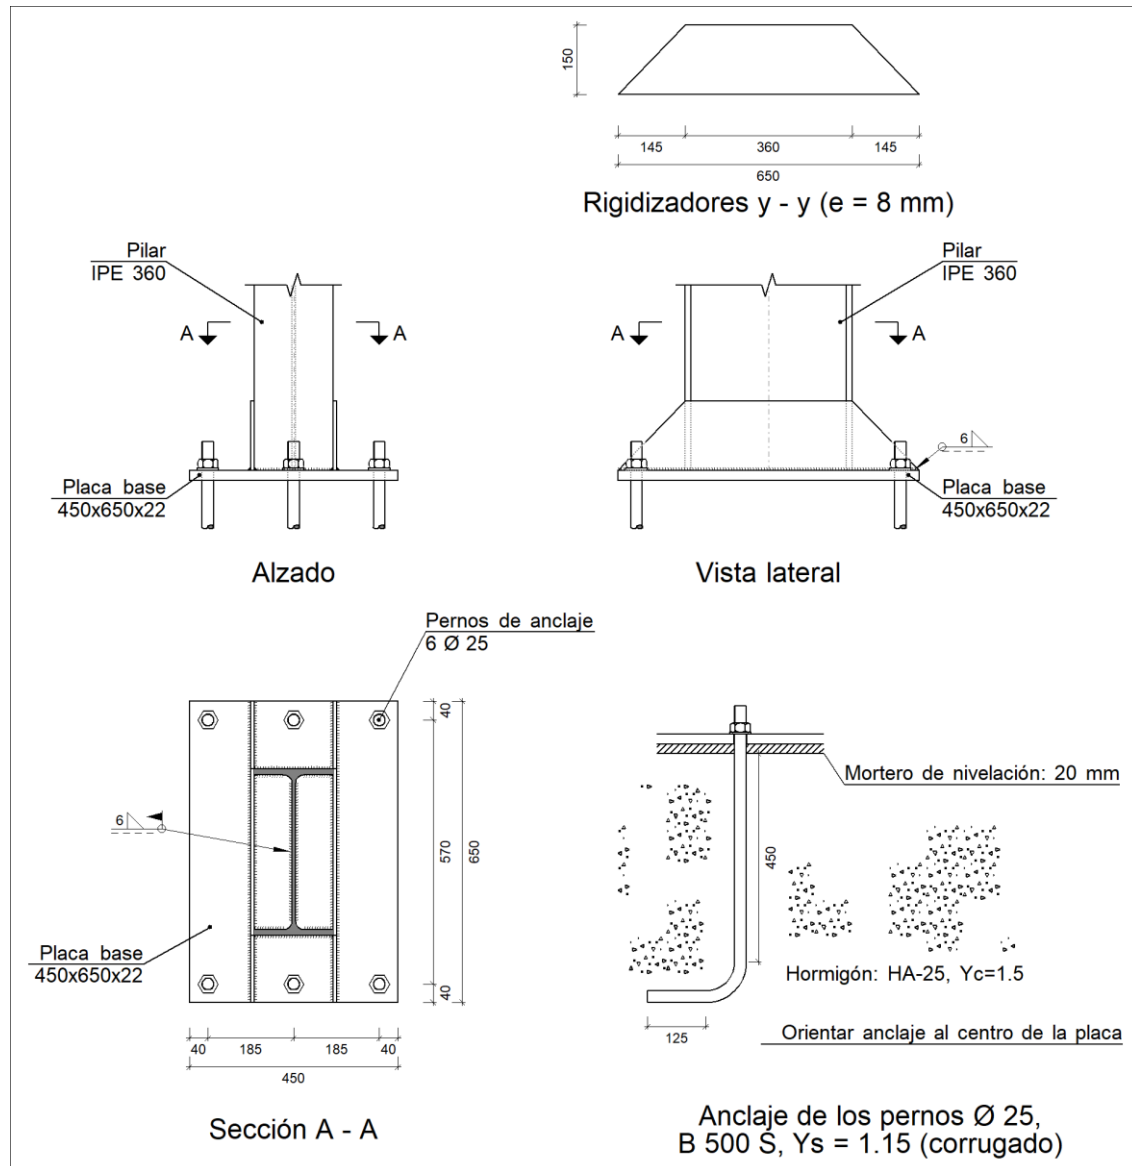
PLACA DE ANCLAJE TIPO 7 (PLANO 15)
